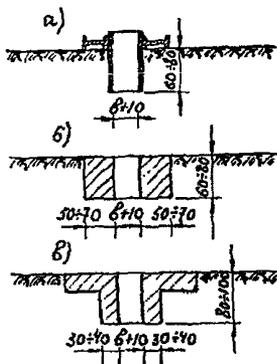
Конструкция воротников: а - металлический; б - бетонный; в - железобетонный (в - ширина рейфера; на рисунке размеры даны в см)
